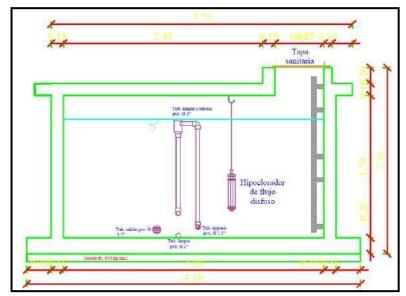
Elevación reservorio sección cuadrada Fuente: Elaboración propia
